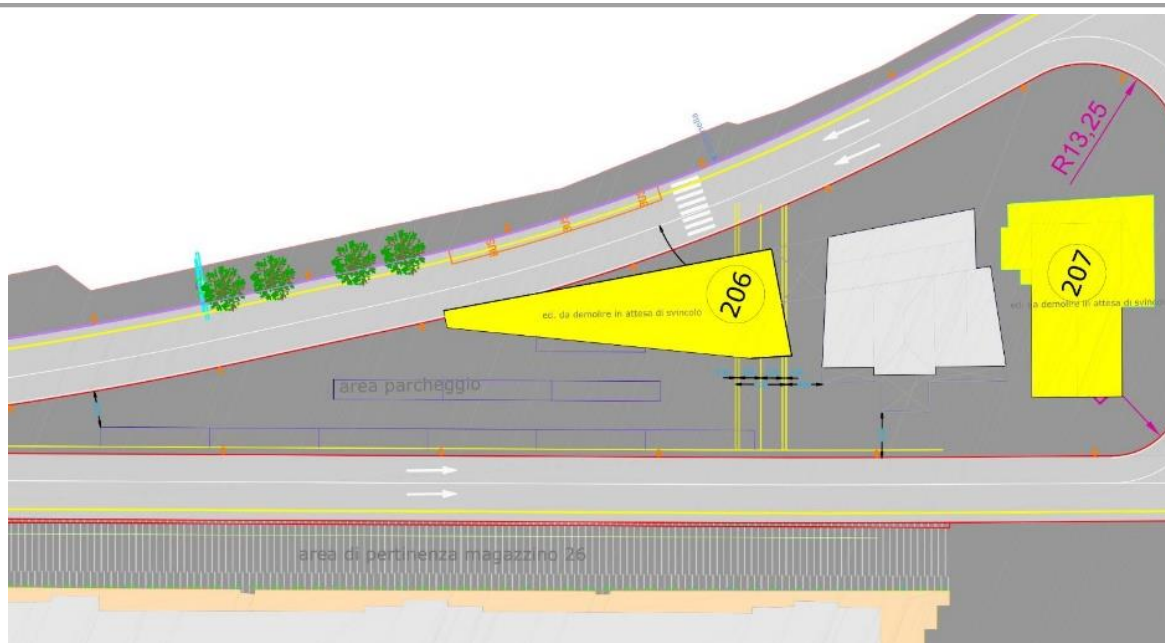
planimetrie aree esterne retrostanti il Magazzino 26
